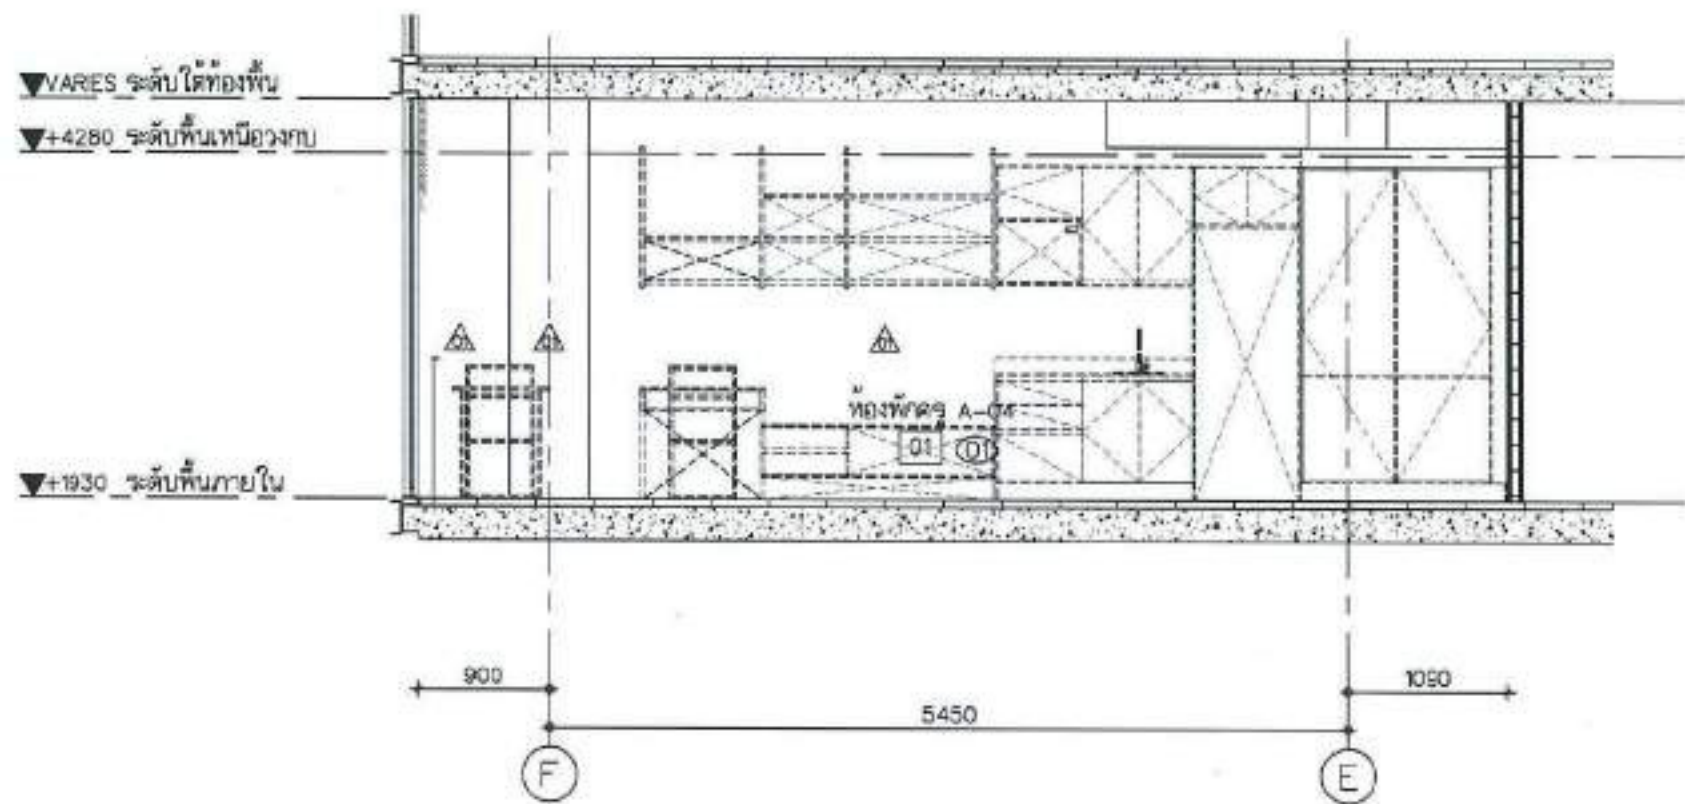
RENOVATION PLAN:แบบขยาย ห้องพัสดุ A-04
